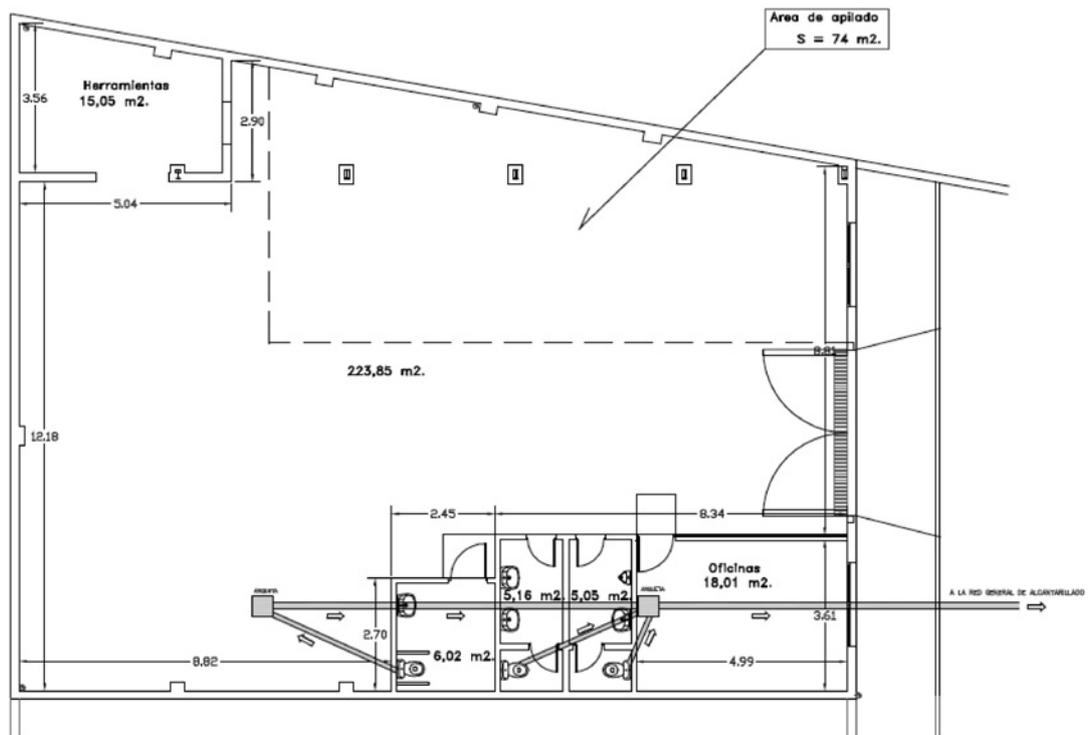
Plano en planta de la instalación en el que se muestran cotas y superficies.
